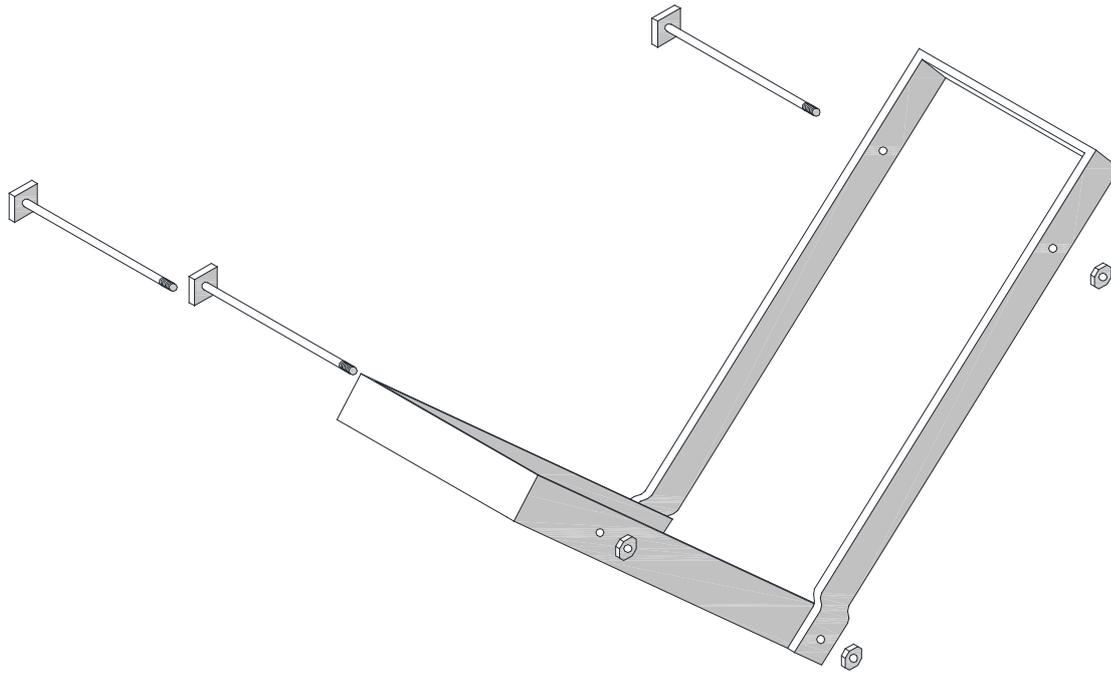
Reithalle Aarau, Eisenbügel zur Sicherung der Verbindung Hängesäule/Hauptstreben
